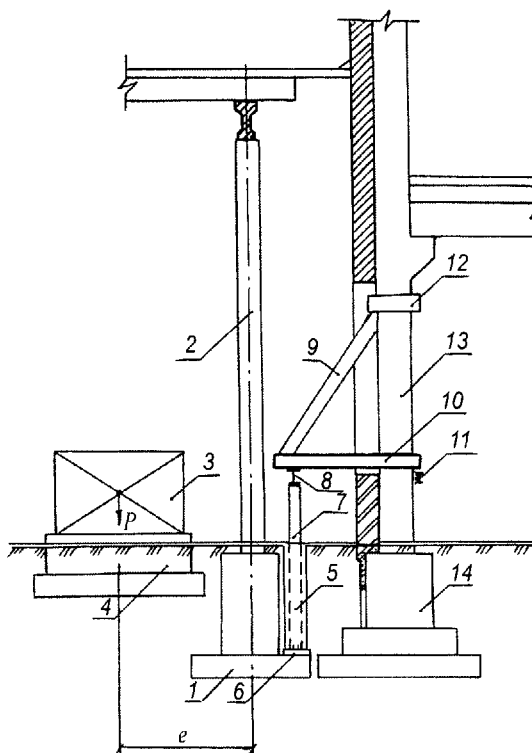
Схема усиления фундамента, расположенного вблизи существующего здания (в стесненных условиях): 1 – усиливаемый фундамент; 2 – колонна реконструируемого здания; 3 – дополнительное оборудование, устанавливаемое в помещении реконструируемого здания; 4 – фундамент под дополнительное оборудование, устанавливаемое при реконструкции здания; 5 – металлическая труба; 6 – опорная металлическая пластина; 7 – стойка из металлической трубы; 8 – распределительная металлическая балка; 9 – металлический подкос; 10 – несущая металлическая балка; 11 – упорная металлическая балка; 12 – обойма вокруг колонны (металлическая или железобетонная); 13 – колонна примыкающего здания; 14 – фундамент примыкающего здания
